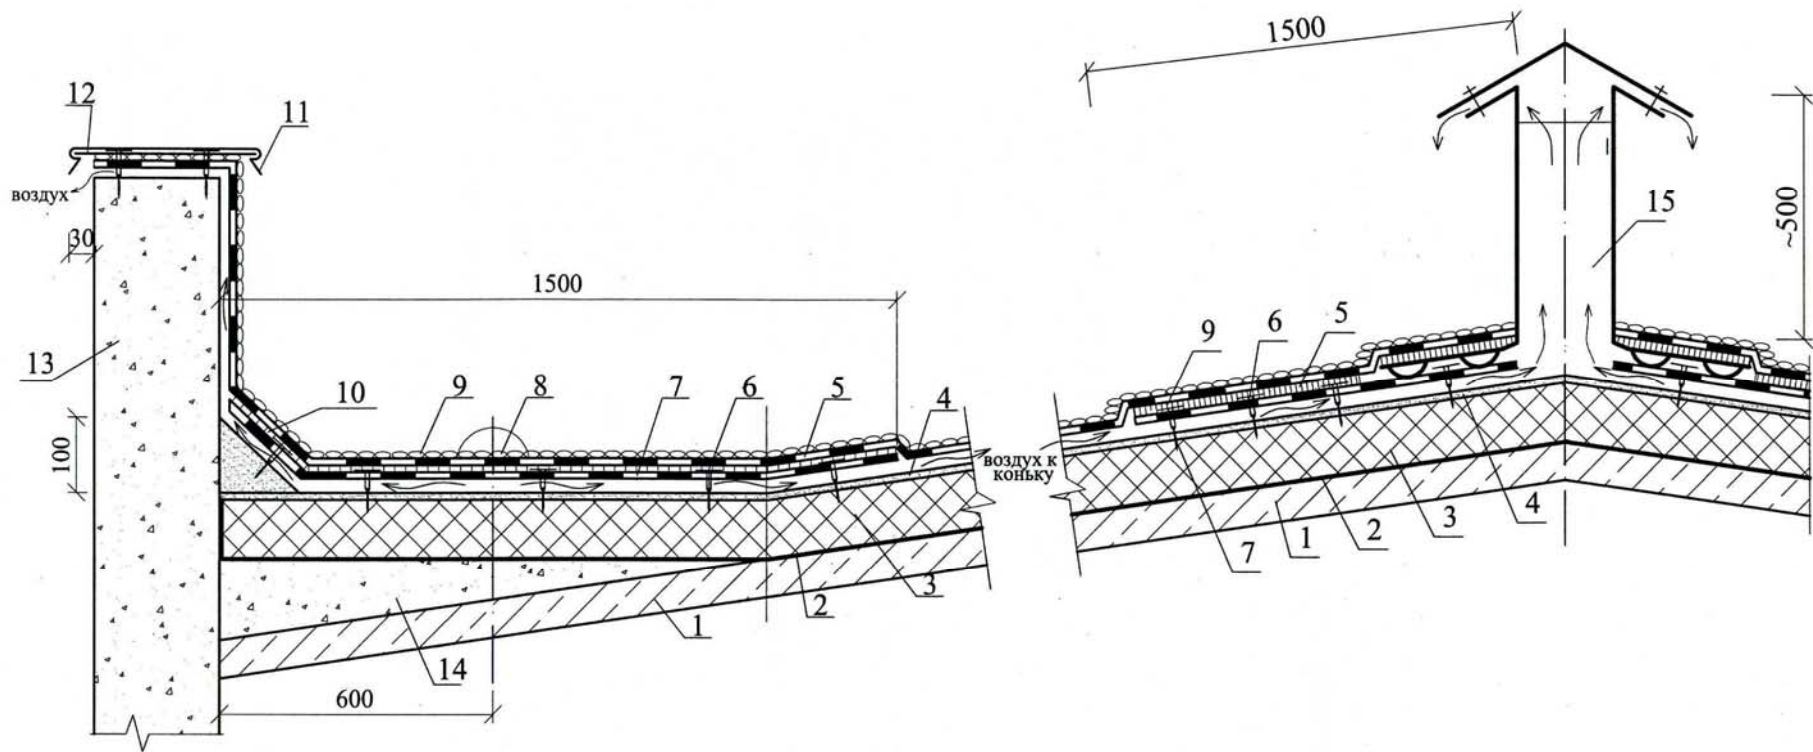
Водоизоляционный ковер на карнизе покрытия с несущим железобетонными плитами
